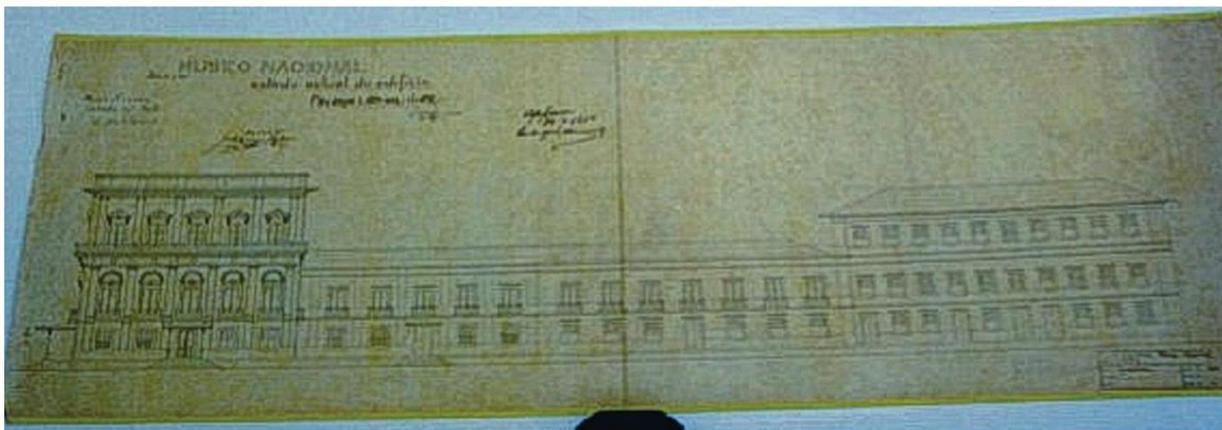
Fachada Norte do Paço em 1910 – Levantamento
